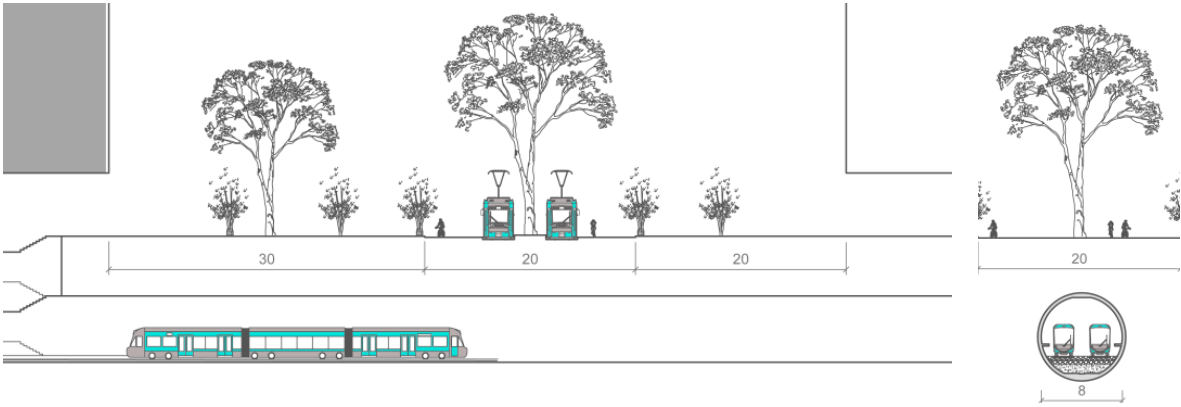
Corte vial Metro ligero y Tranvía - Autores
